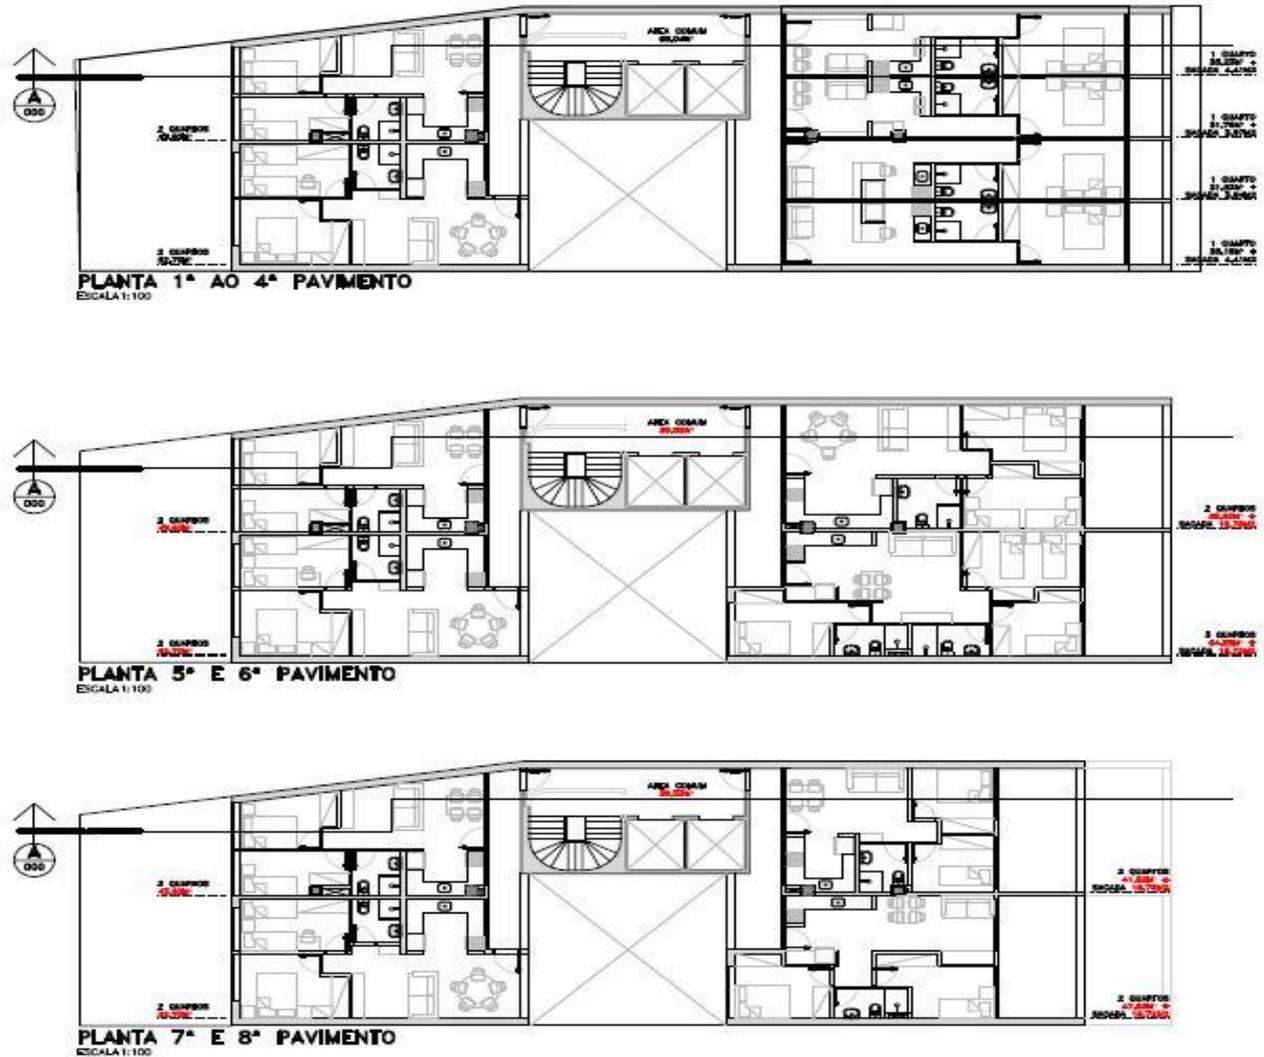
Planta dos Apartamentos: do 1º ao 8º pavimento
